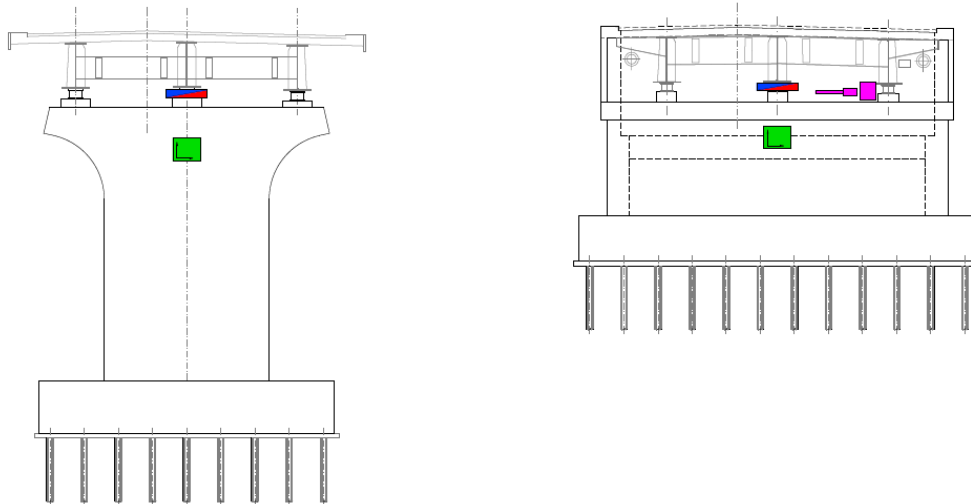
Schema posizionamento strumentazioni pila viadotti (sx) e spalla (dx) viadotti
